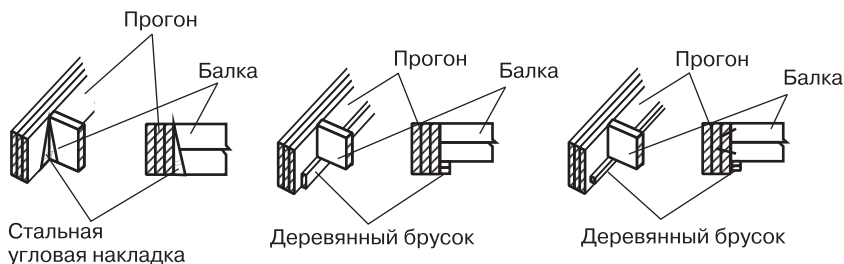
Опираение балок перекрытия на каркас наружной стены
